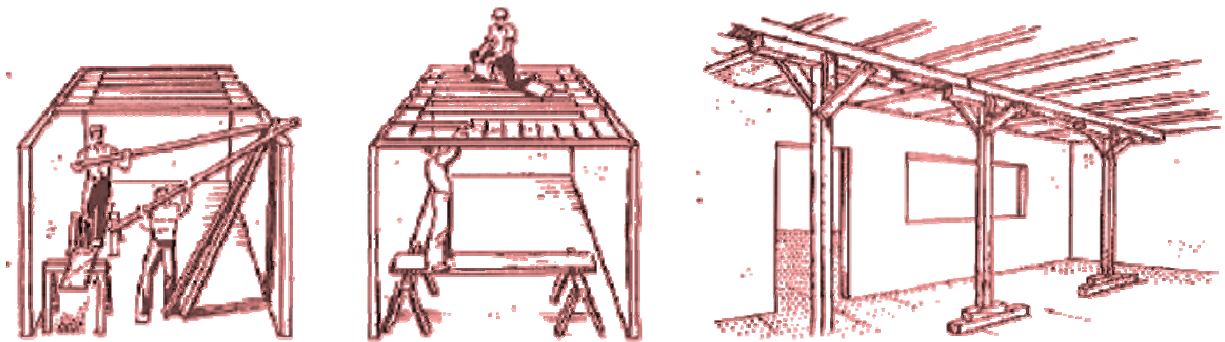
Colocación de viguetas y bloques sobre apuntalamiento y estructura.
